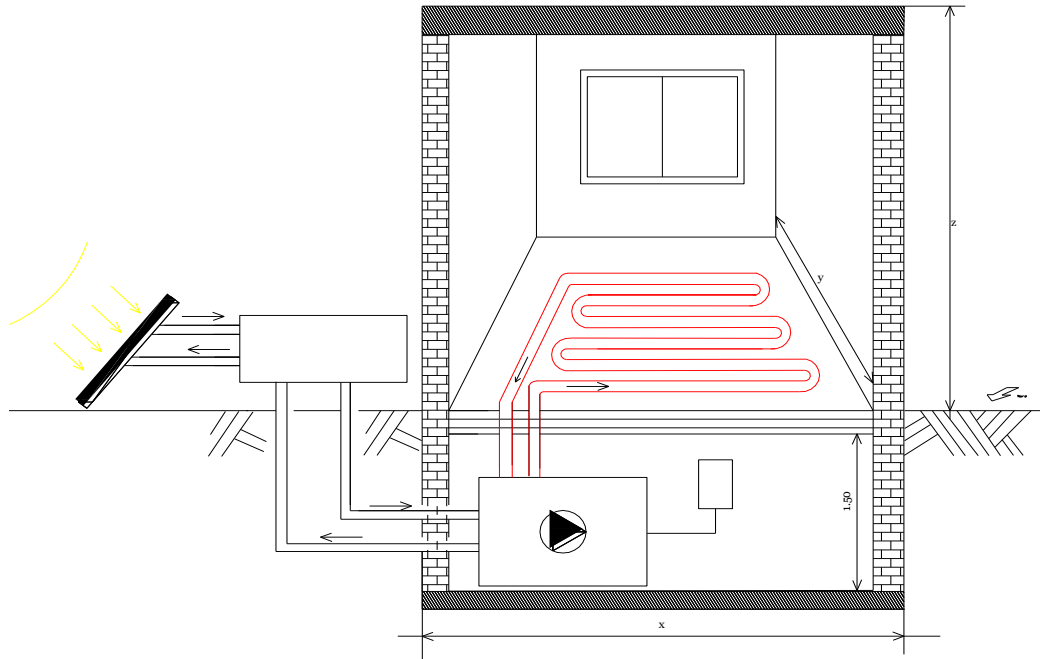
Configuration schématique d'une zone singulière à plancher chauffant.
